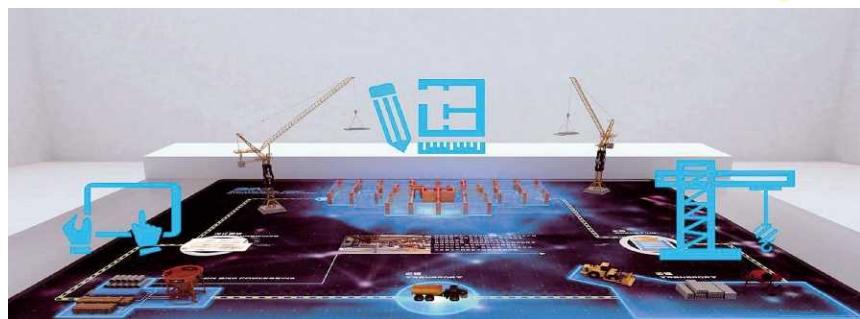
BIM 施工现场布置 + 施工模拟系统示意图
